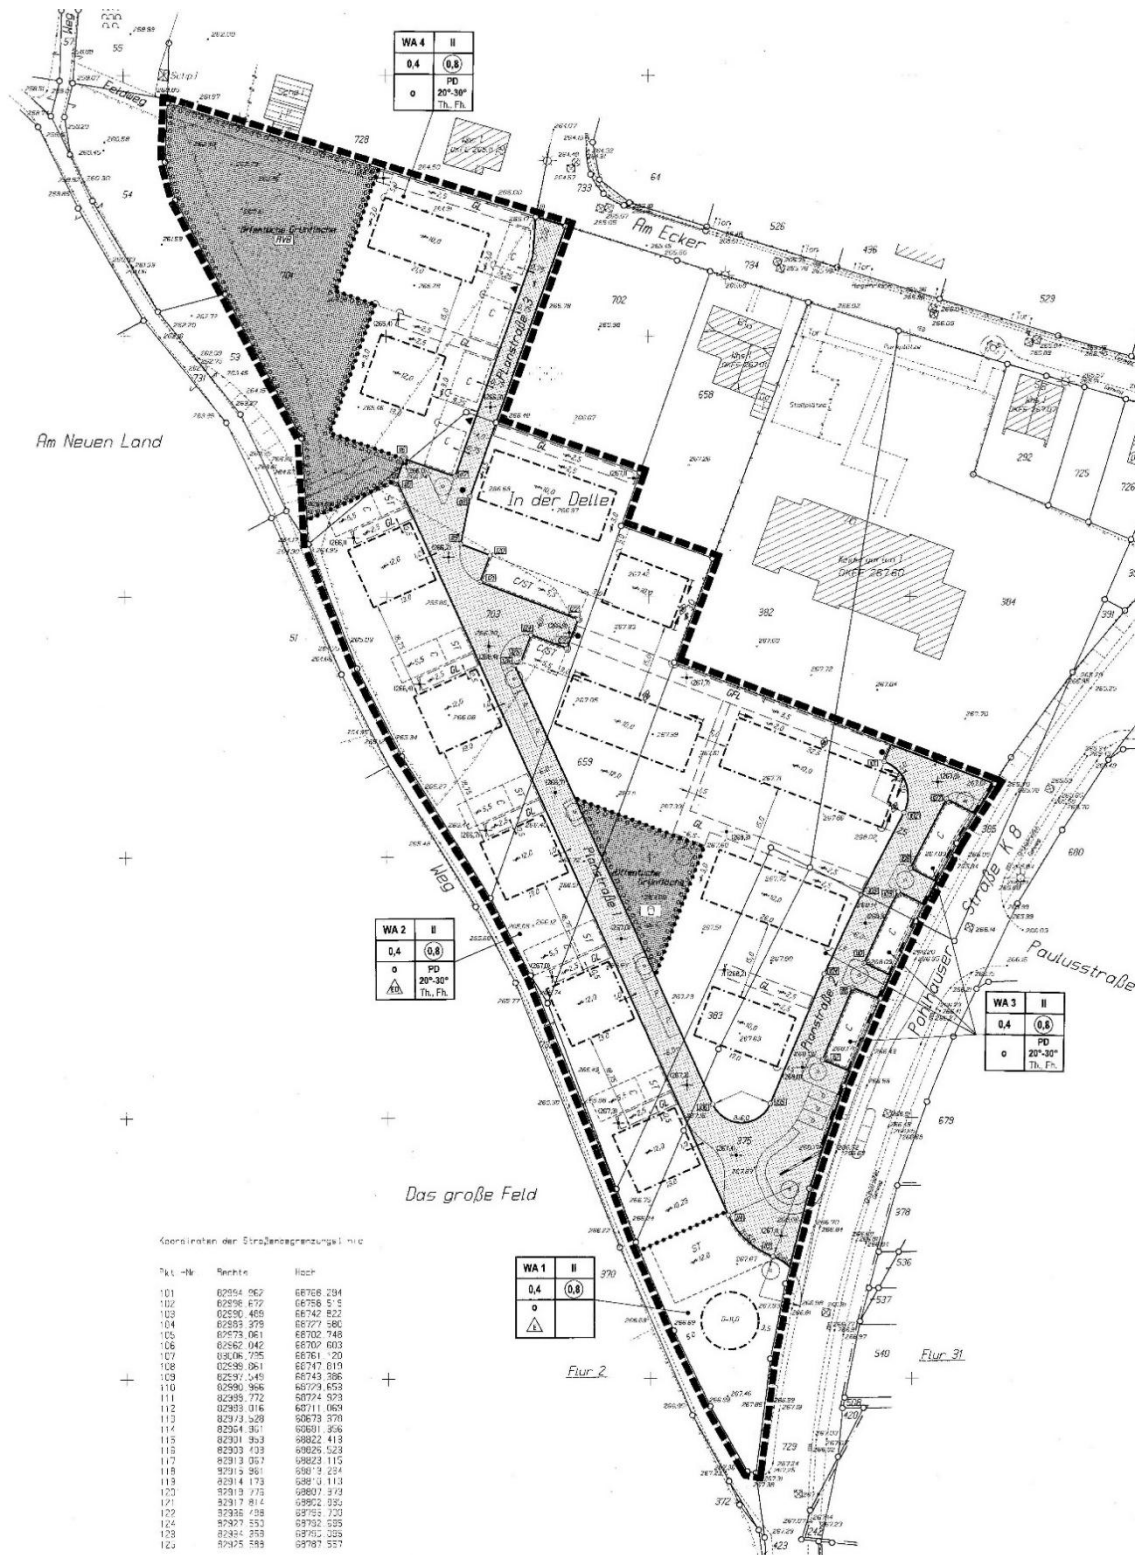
Bebauungsplan Nr. 57 „Solarsiedlung Pohlhausen West“ (2004) (Quelle: Stadt Wermskirchen)
